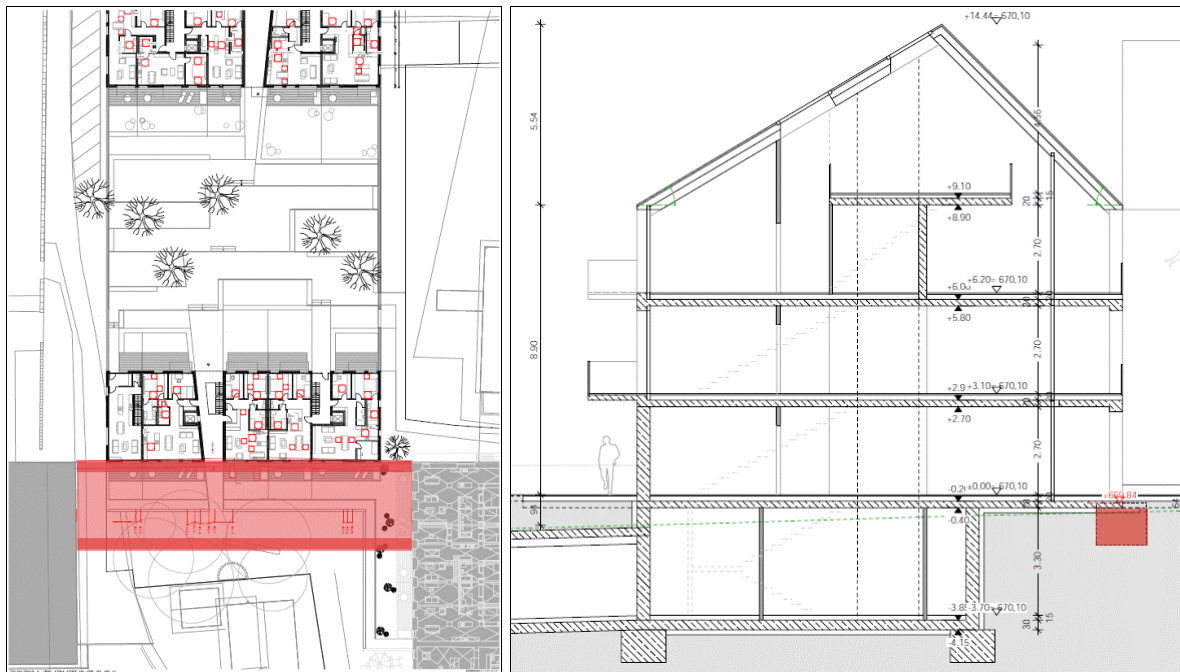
Links: Grundriss der geplanten Neubebauung. Ehemaliger Prälatenstock rot einschraffiert. Oben ist Nord-Nord-Westen. Rechts: Schnitt durch den geplanten Neubau gegen Ost-Nord-Ost mit Überdeckung des alten Fundaments (rot eingefärbt). Quelle: Kehrbaum Architekten.
